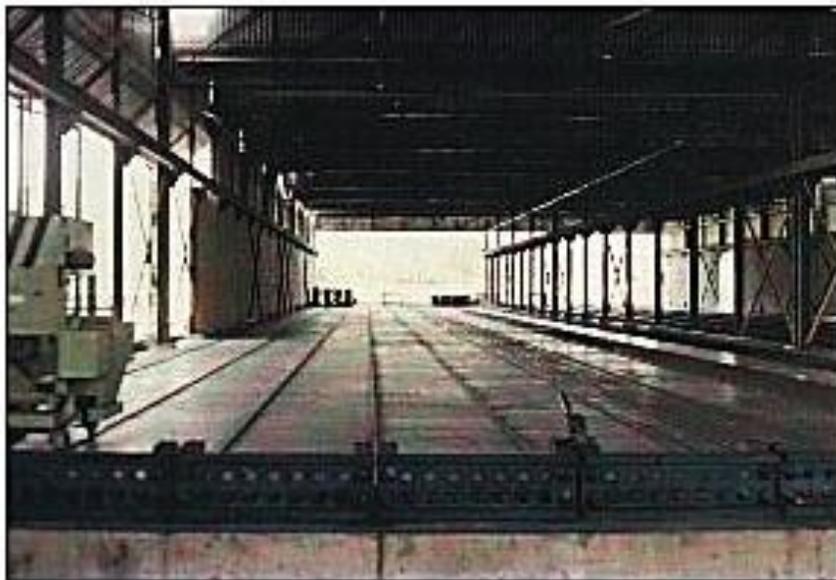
Vista de la Pista de fabricación de columnas y Vigas “T” invertidas. Fuente: Ing. Luis M. Sanz (2015)
